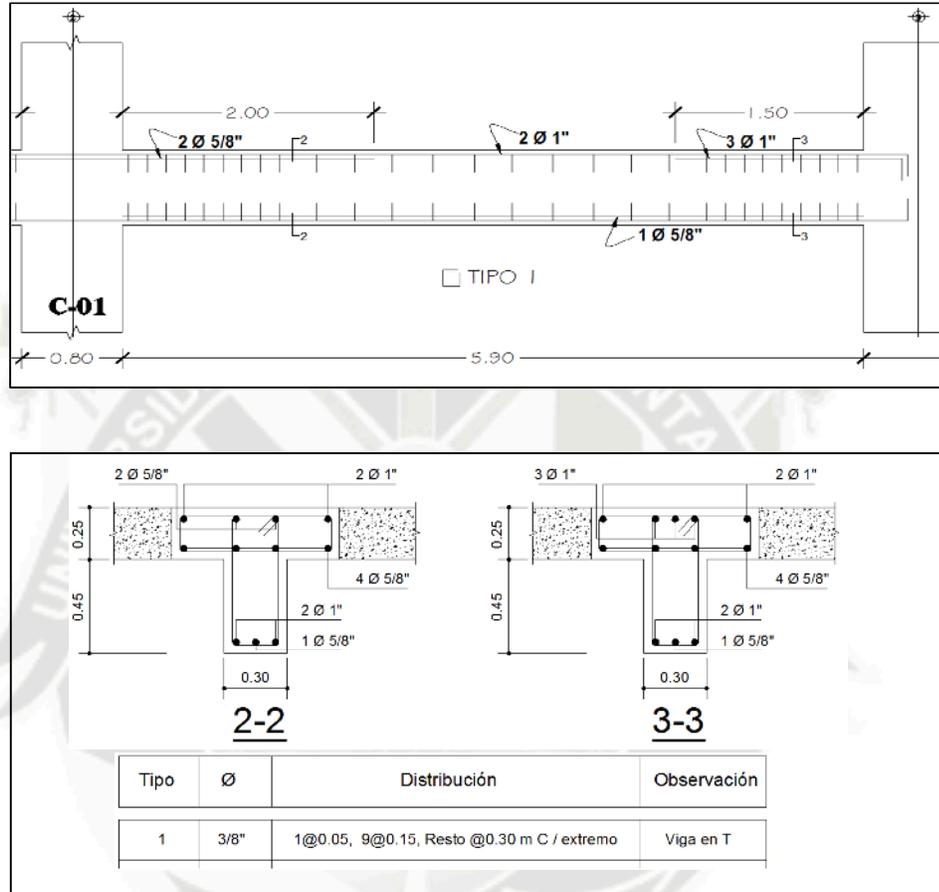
Diseño Final de Tramo Seleccionado de la Viga T V-007 - Sótano.
